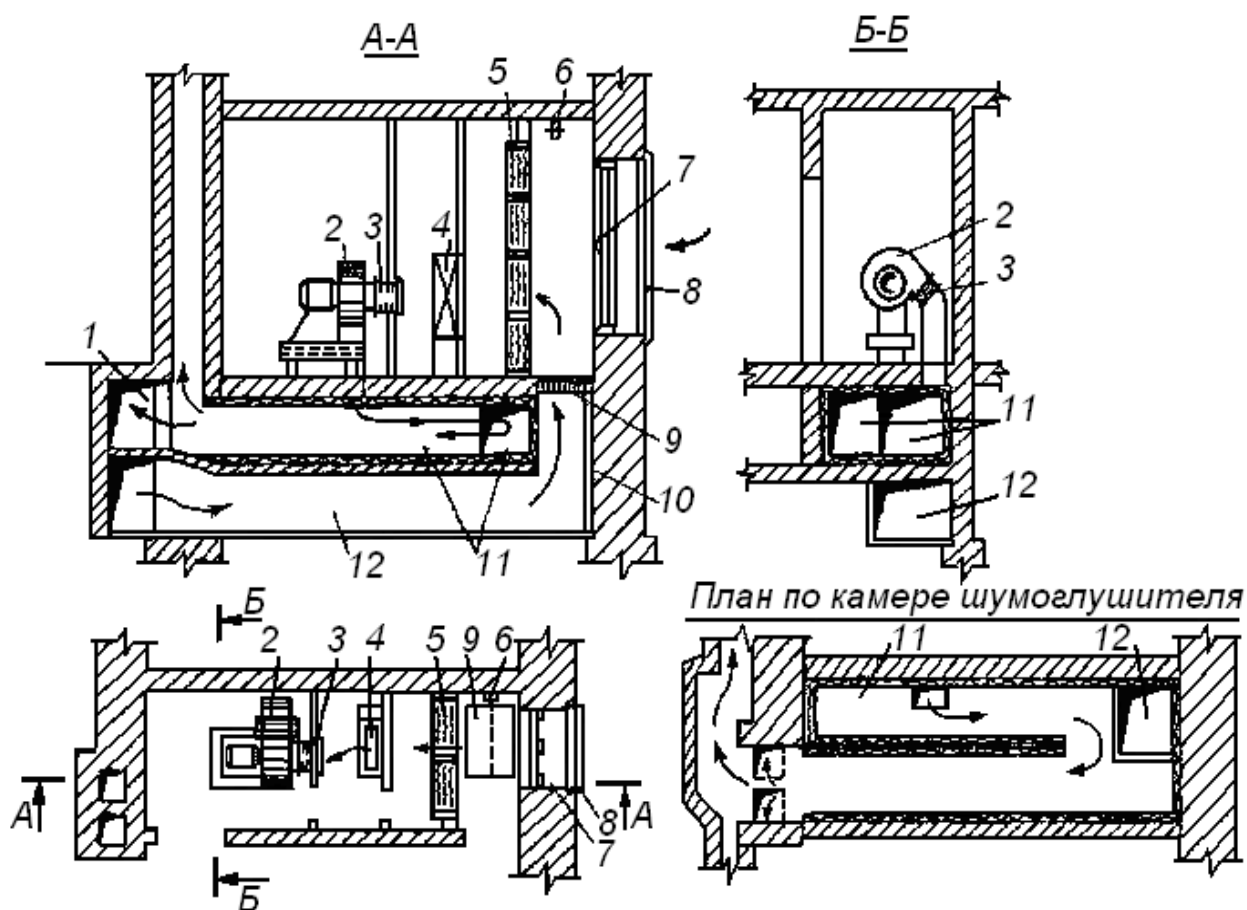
Приточная камера: 1 – приточный короб; 2 – центробежный (радиальный) вентилятор; 3 – гибкий патрубок; 4 – калорифер; 5 – фильтры; 6 – утепленный клапан; 7 – жалюзийная решетка; 8 – рециркуляционный клапан; 9 – звукопоглощающее покрытие; 10 – короб шумоглушения; 11 – рециркуляционный короб
